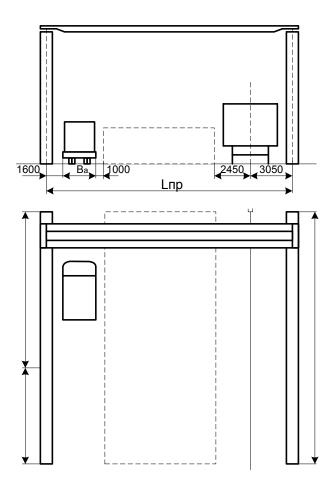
Поперечный разрез и план открытой площадки с мостовым краном (автопроезд – продольный)
